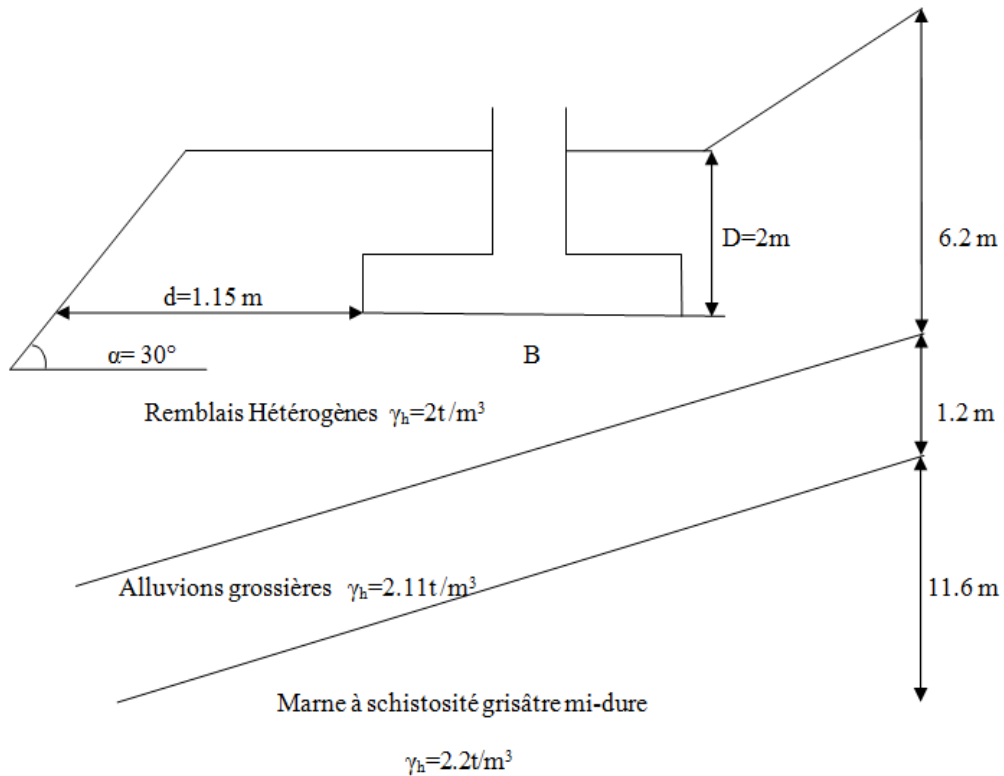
coupe sur le sol sous la fondation (SPI).
